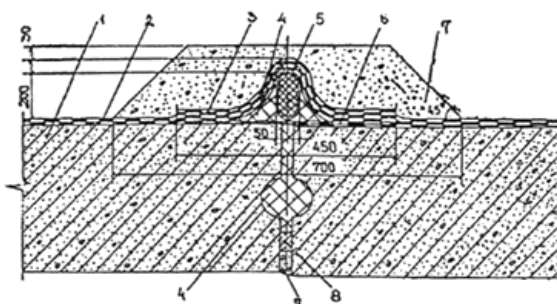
Конструкция гидроизоляции деформационного шва между стеновыми блоками
